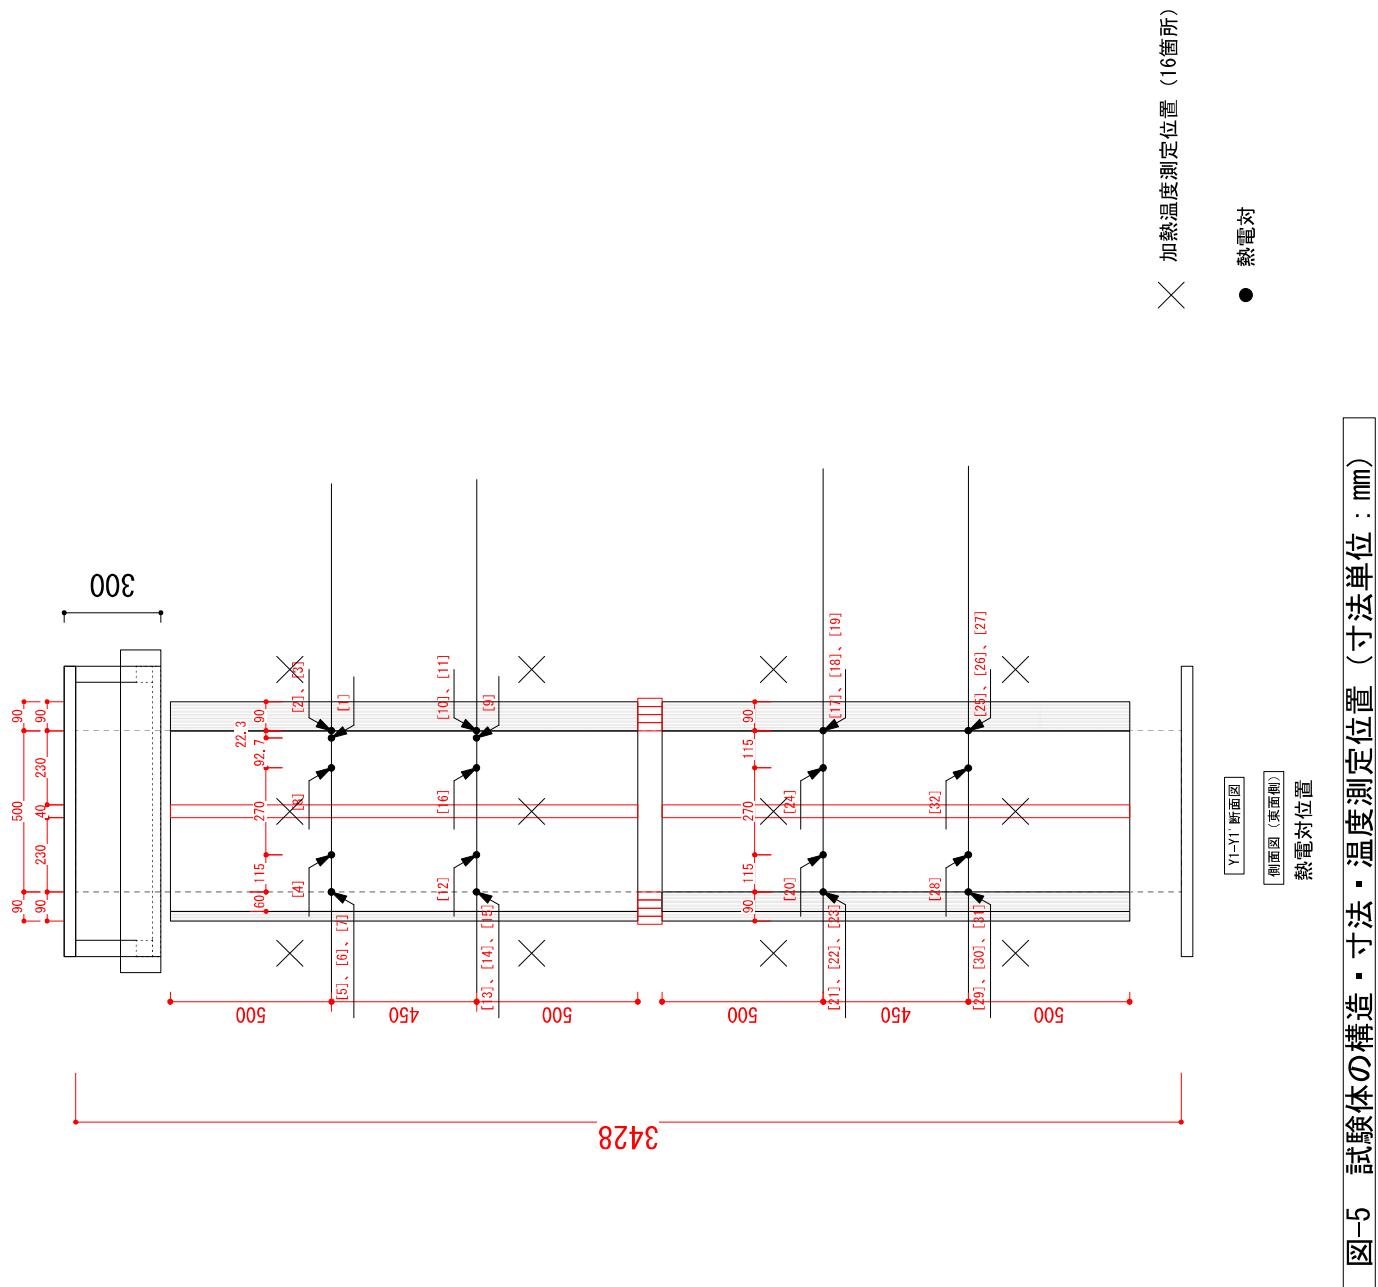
試験体の構造・寸法・温度測定位置（寸法単位：mm）
